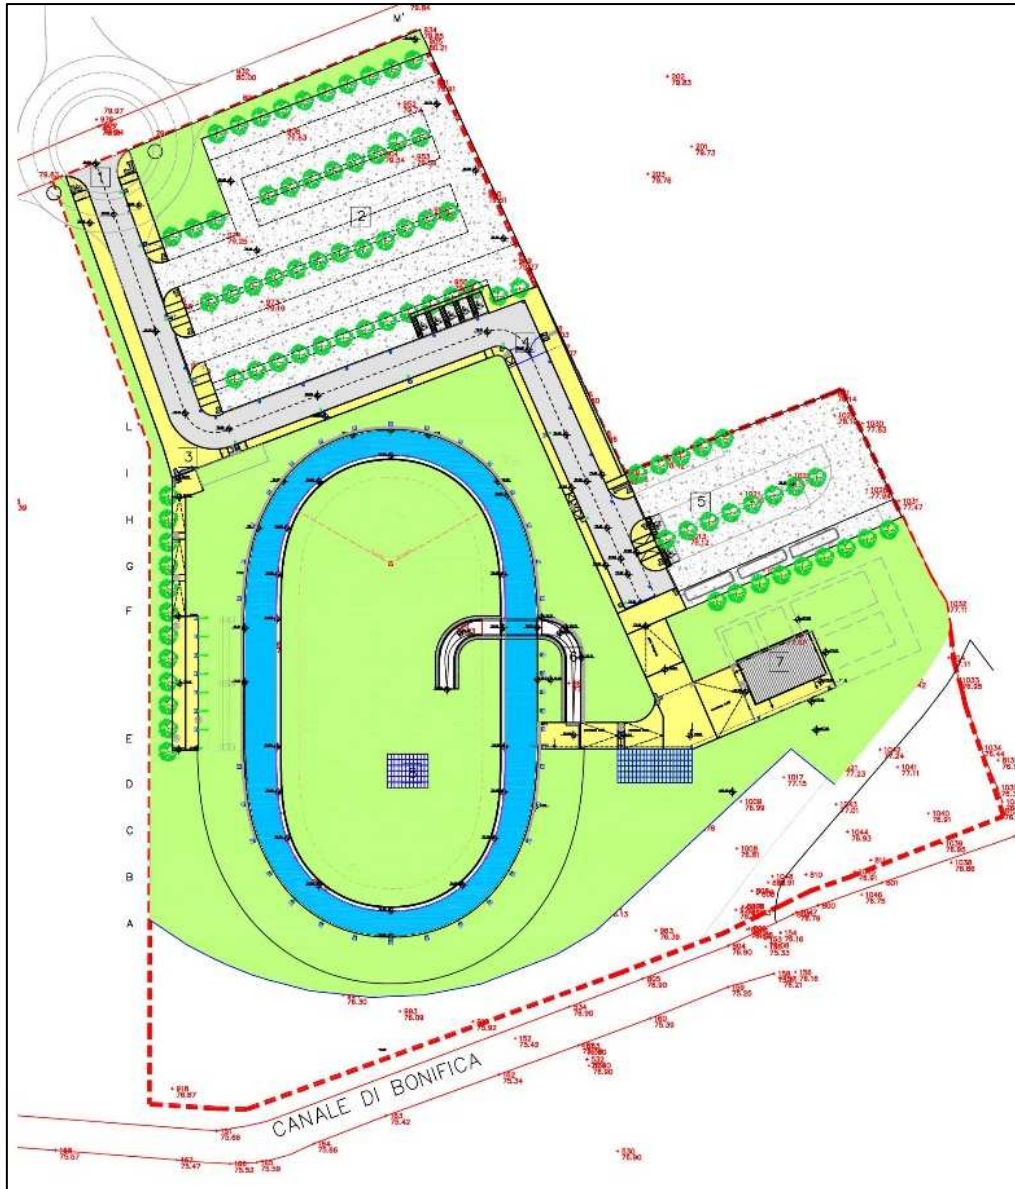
STRALCIO PLANIMETRICO VELODROMO
